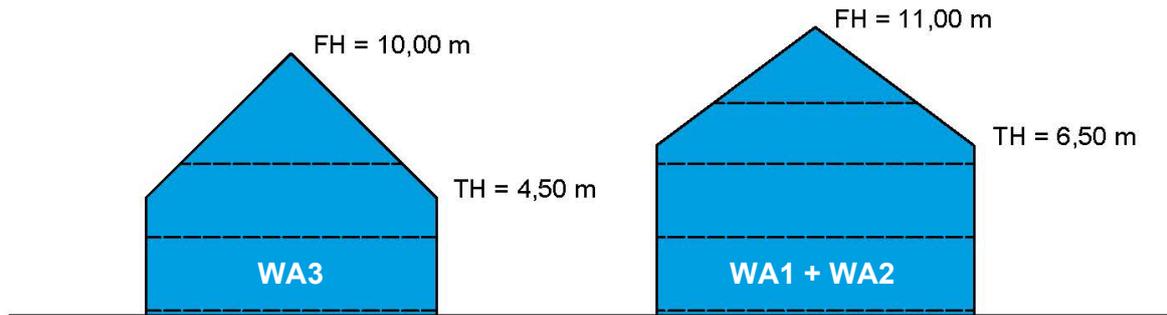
Schemaschnitte der möglichen Bebauung, ohne Maßstab
